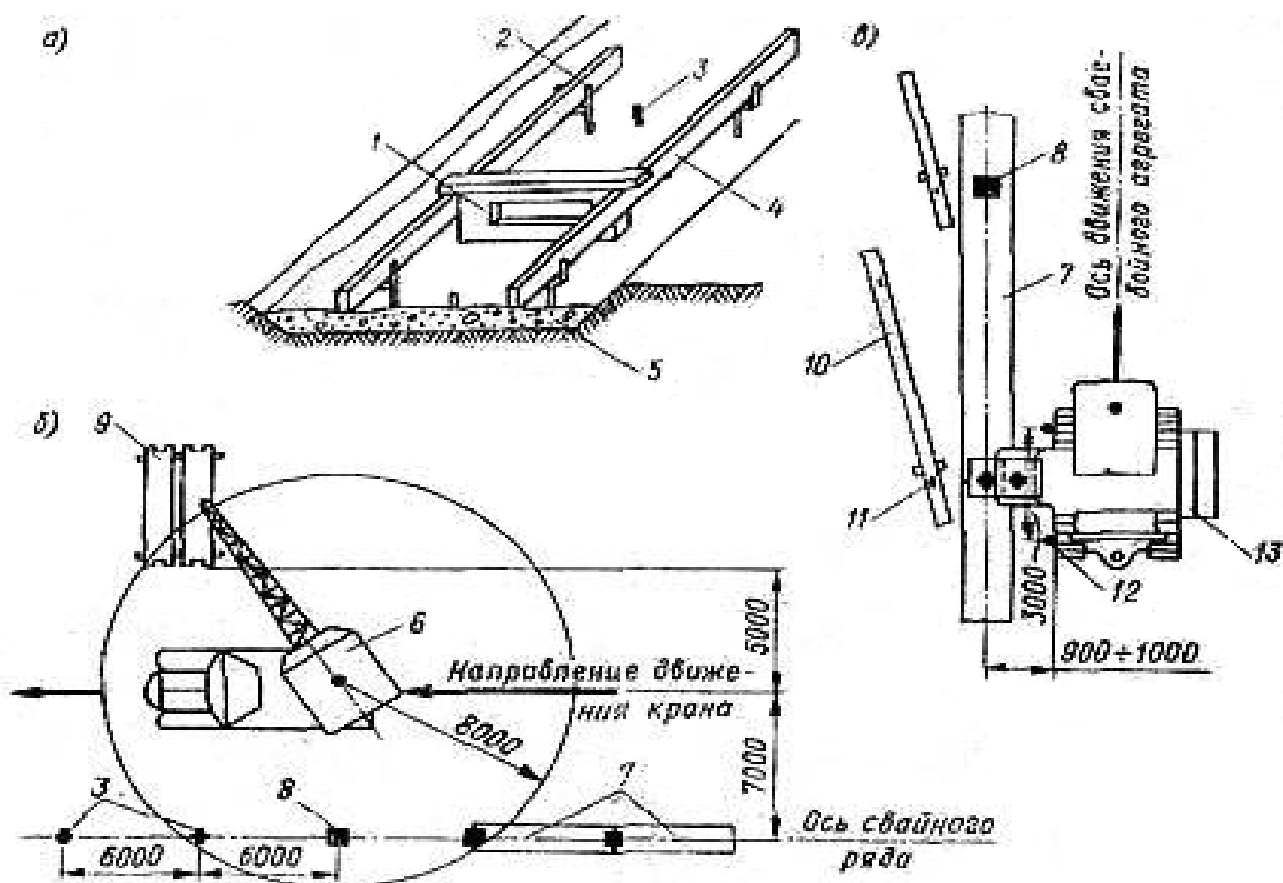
Устройство свайного фундамента полносборного жилого дома.
